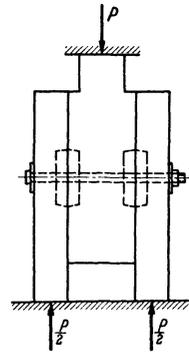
Probekörper zu Druckversuchen mit Holzverbindungen.
